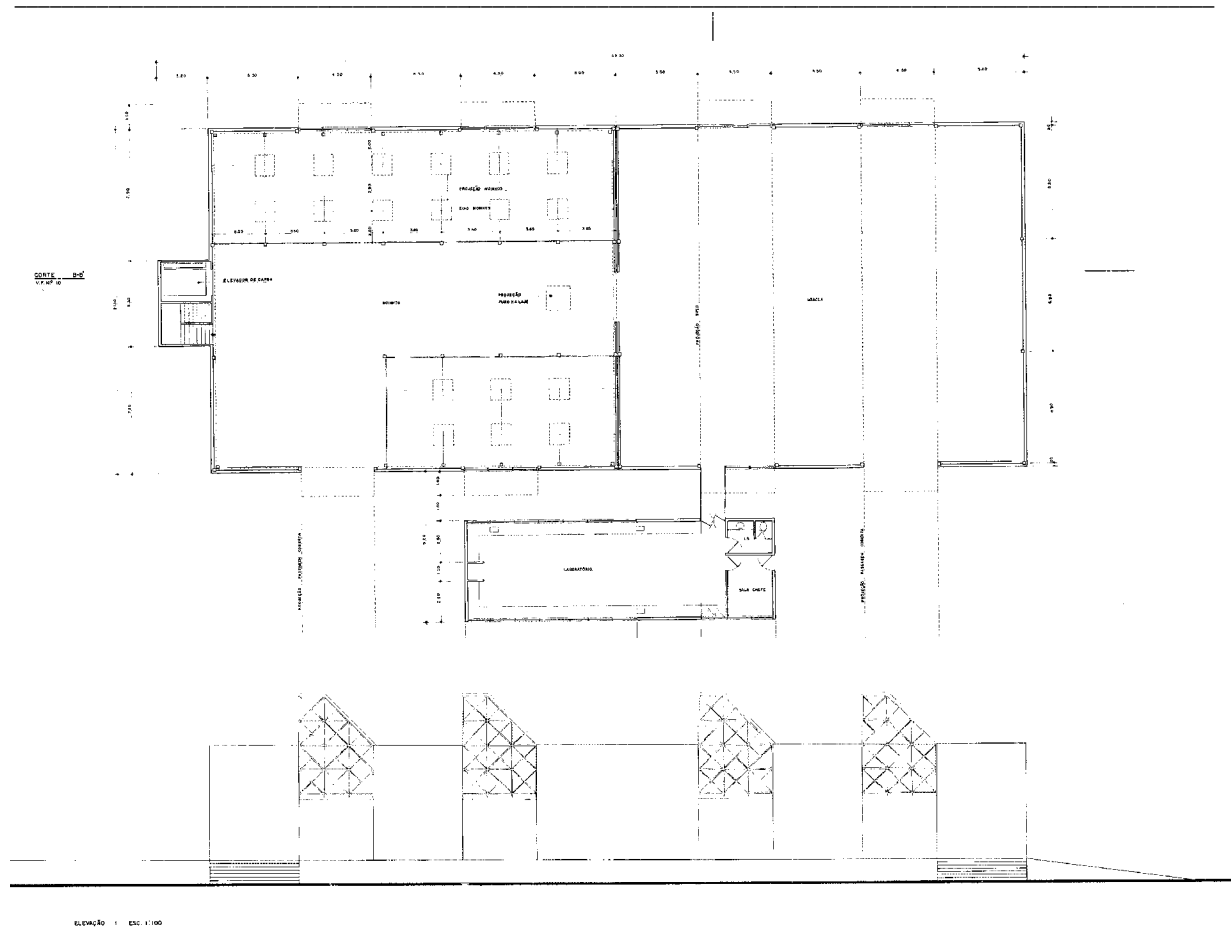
Indústrias de Tintas Renner: planta parcial do pavimento térreo do pavilhão "reservatório de tintas".
